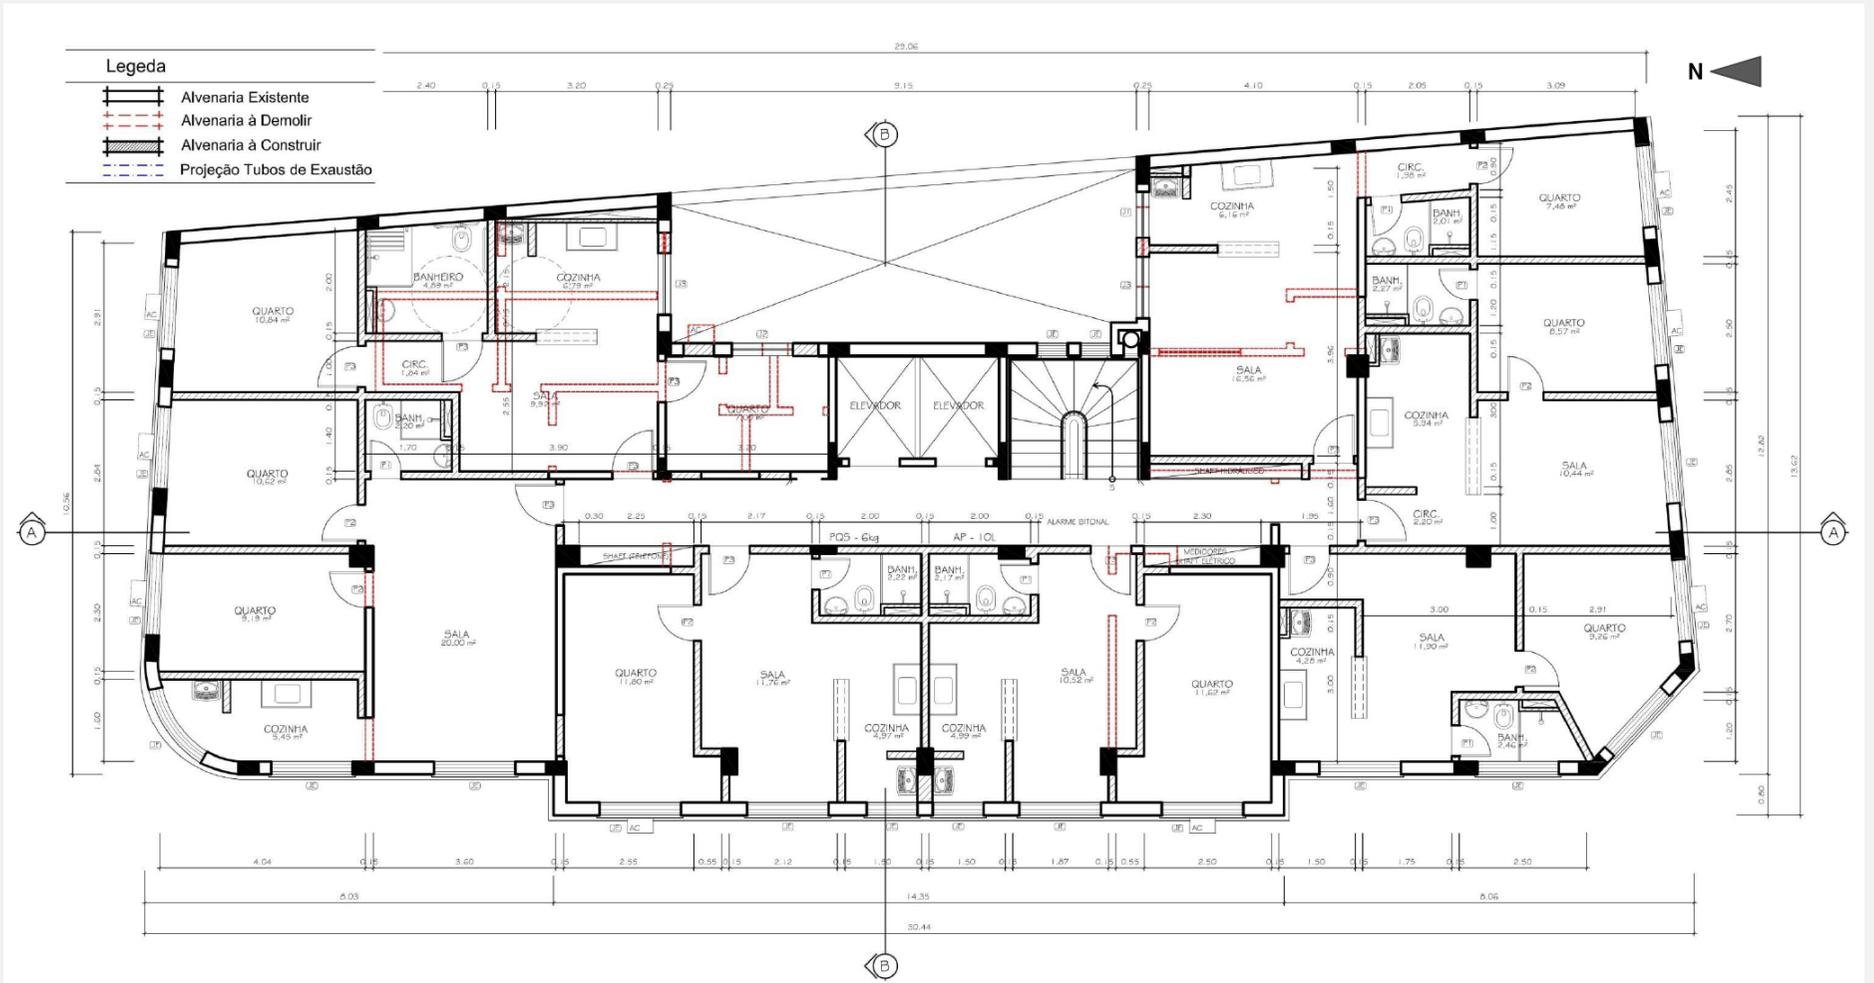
Planta baixa do pavimento-tipo do Ed. INSS do projeto de reabilitação. Sem escala.
